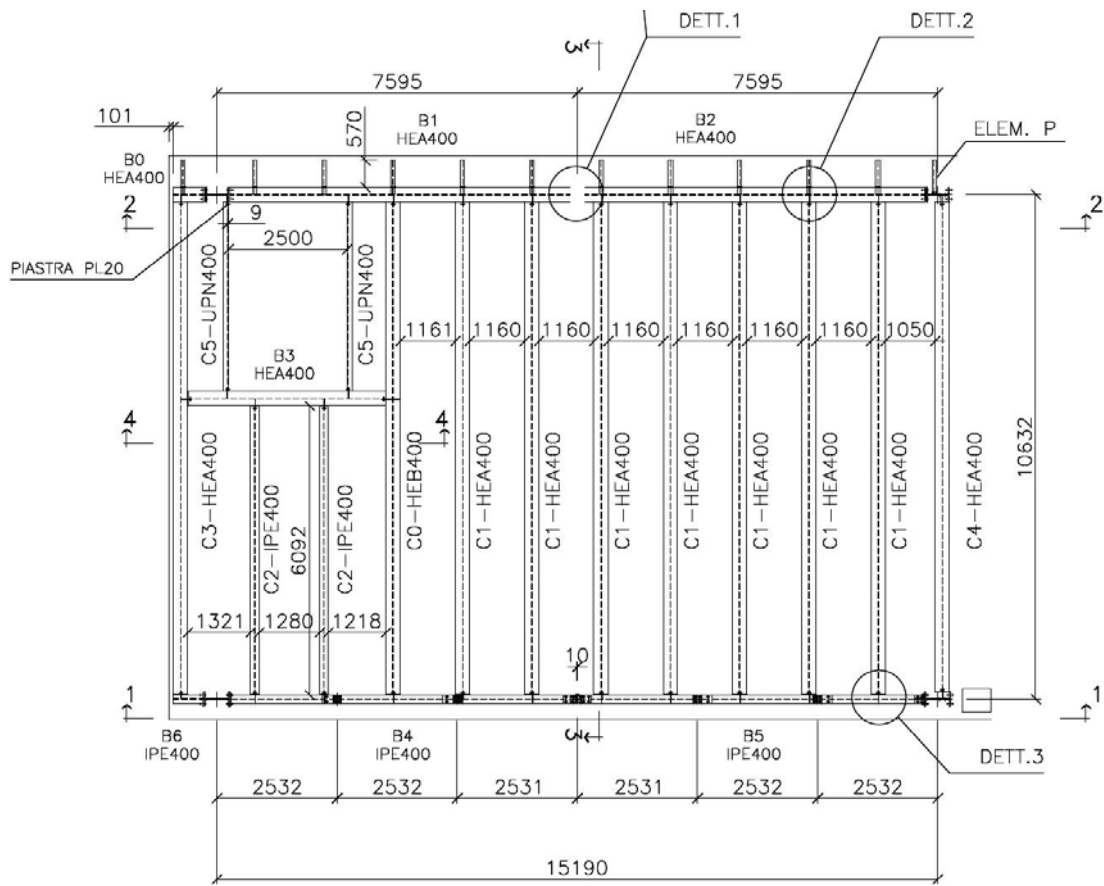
Particolare di A.2007.a.sa.T01 - Progetto della struttura - Pianta
